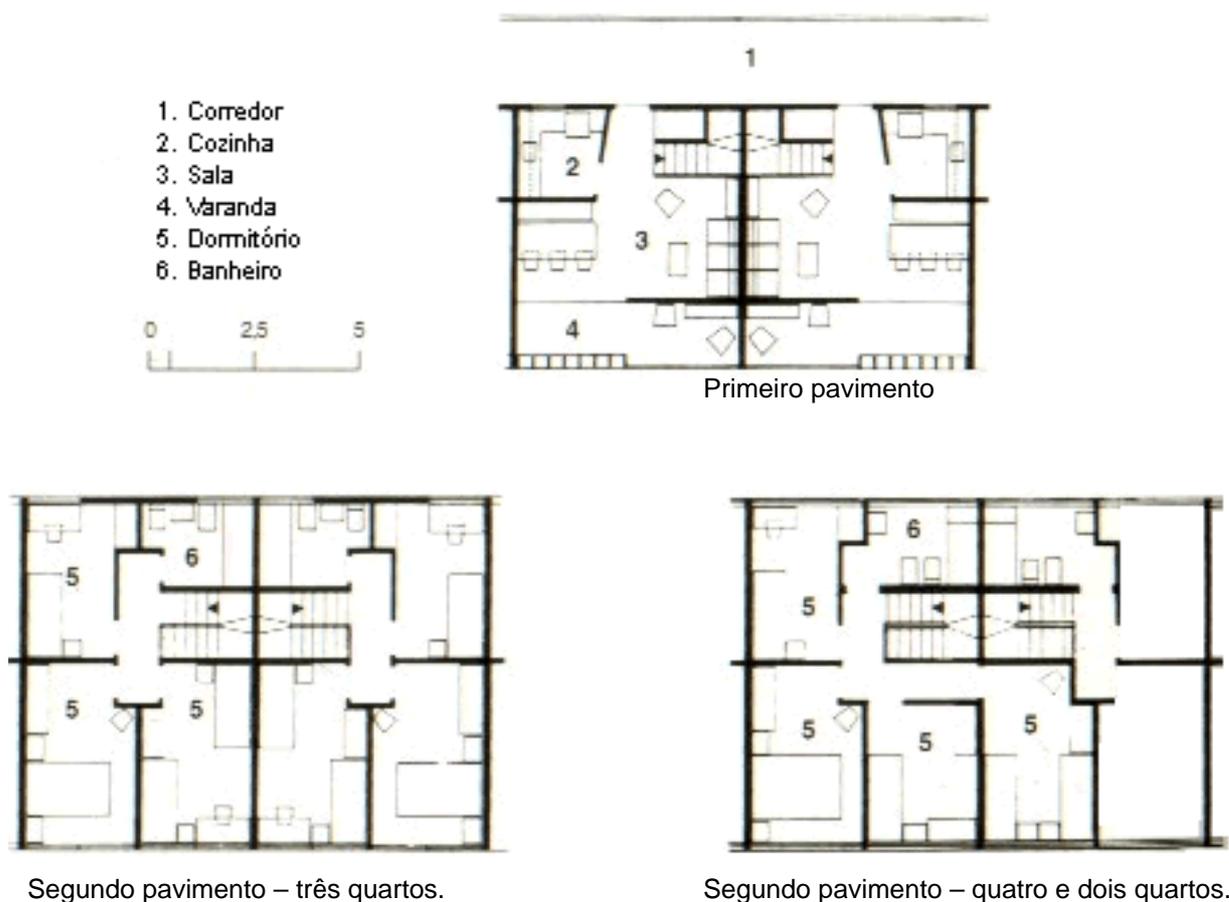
Bloco B: Plantas do primeiro pavimento e as duas alternativas de segundo pavimento.
